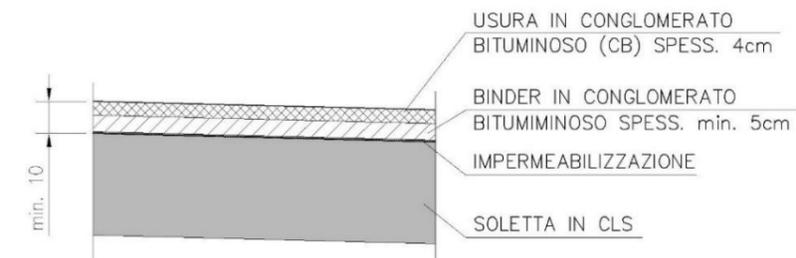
Dettaglio pavimentazione su opera d'arte
